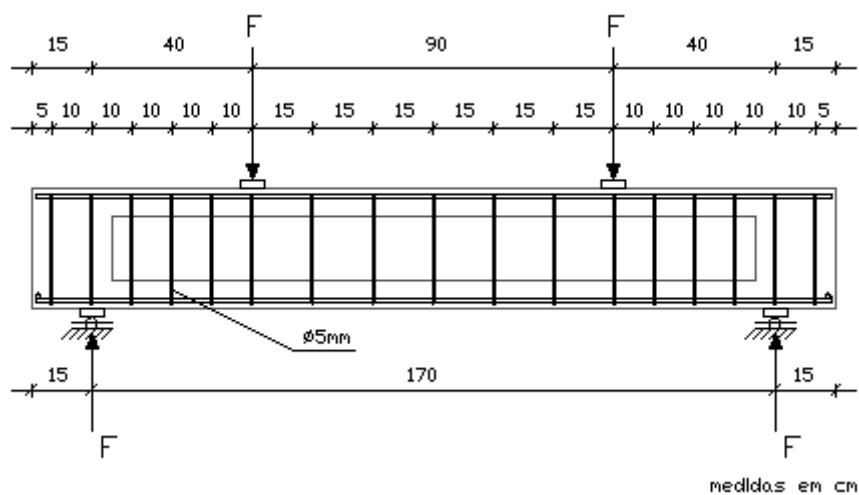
Posição dos estribos, cargas e apoios da viga I-143 A (LEITE JÚNIOR, 2000)
